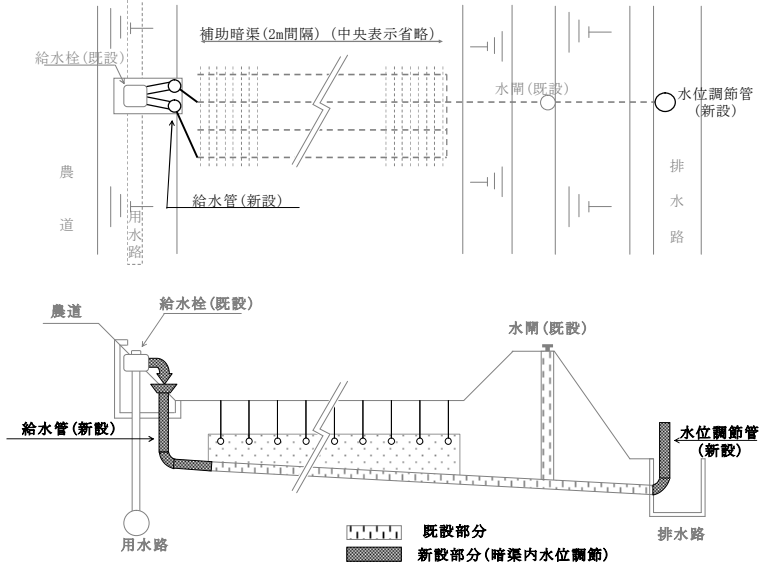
簡易手法の模式図（上:平面図, 下:縦断面図）
